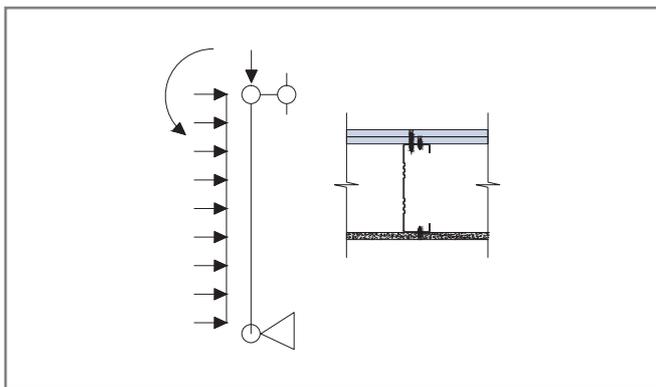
Расчетная схема стойки каркаса стены при воздействии ветровой нагрузки и нагрузки от собственного веса фасада, схема раскрепления полок стойки термопрофиля обшивками КОС
